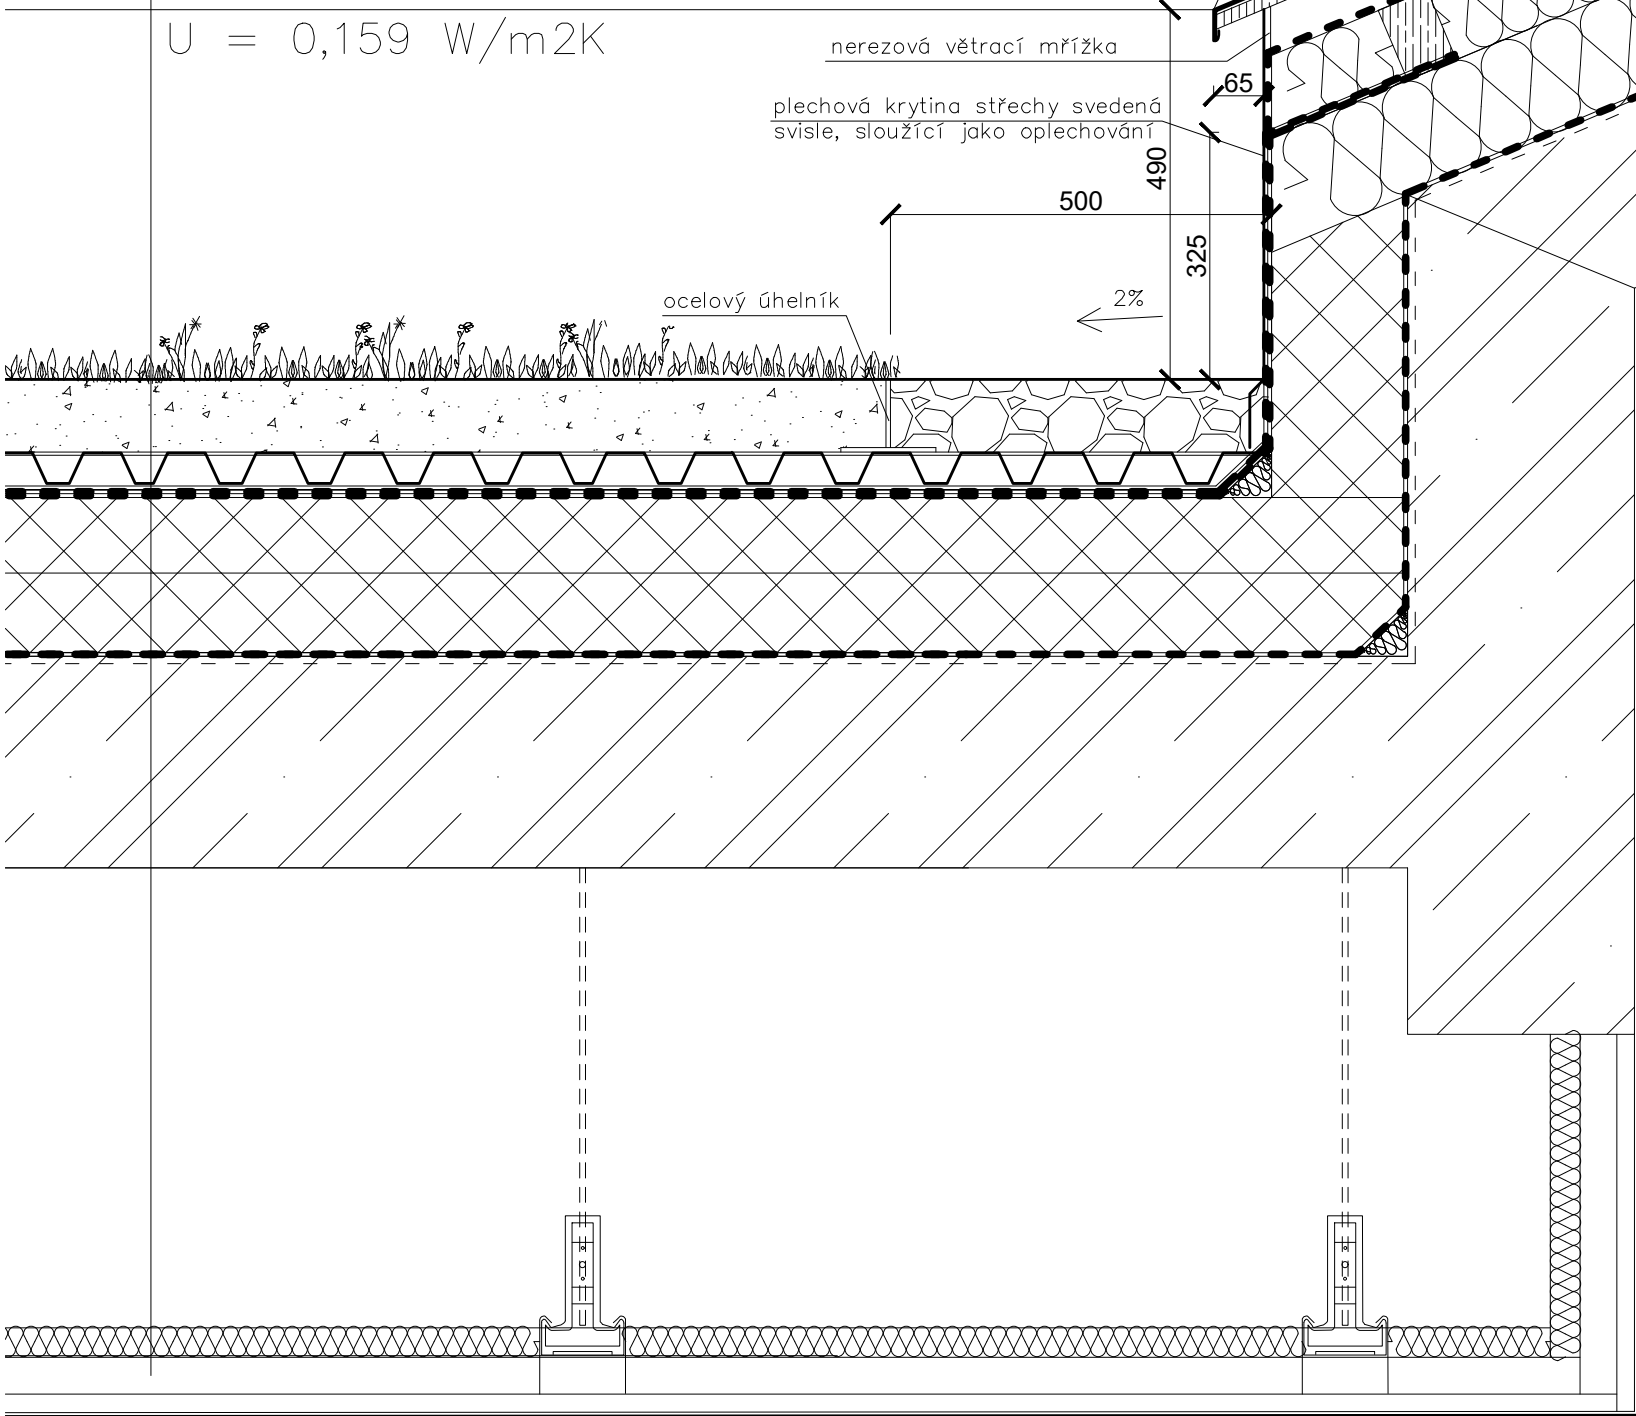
DETAIL ŽLABU ŠIKMÉ STŘECHY, DETAIL NADPRAŽÍ OKNA
